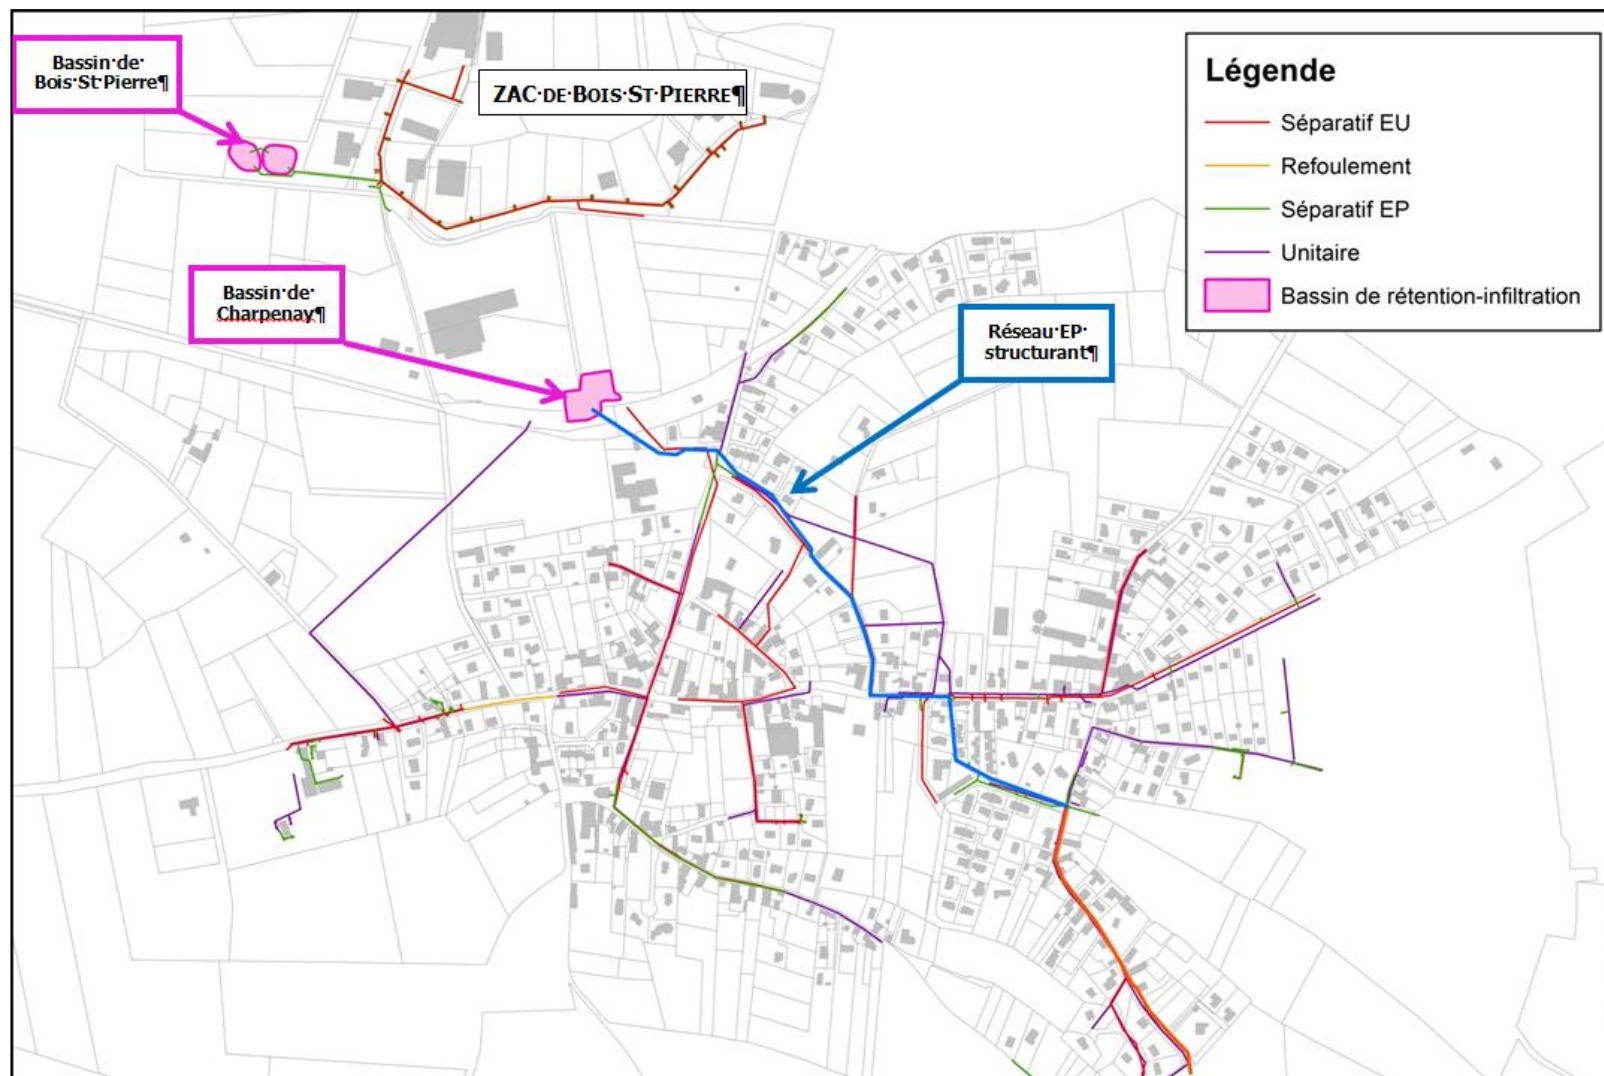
IMPLANTATION DES STRUCTURES PLUVIALES
